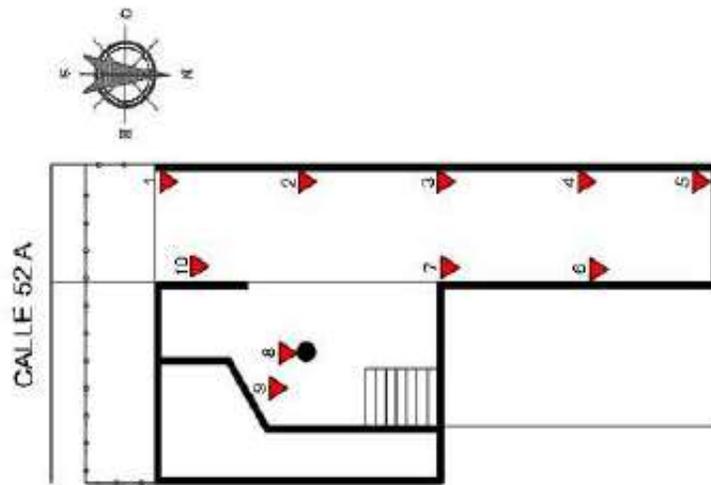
Ubicación de niveles en planta. Fuente: informe topografía.
